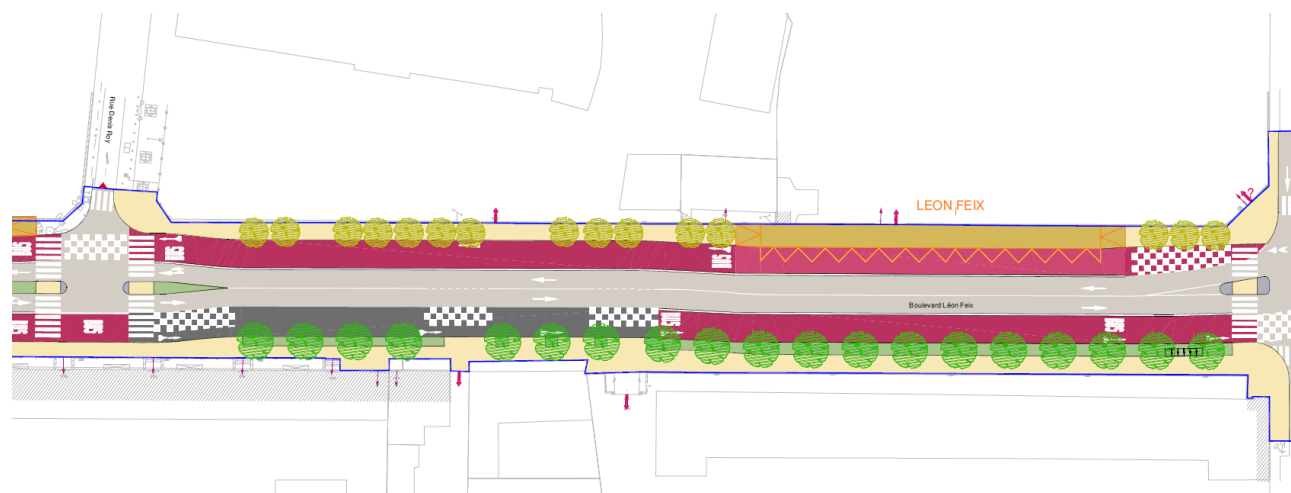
Exemple de surlargeur plantée sur le boulevard Léon Feix
